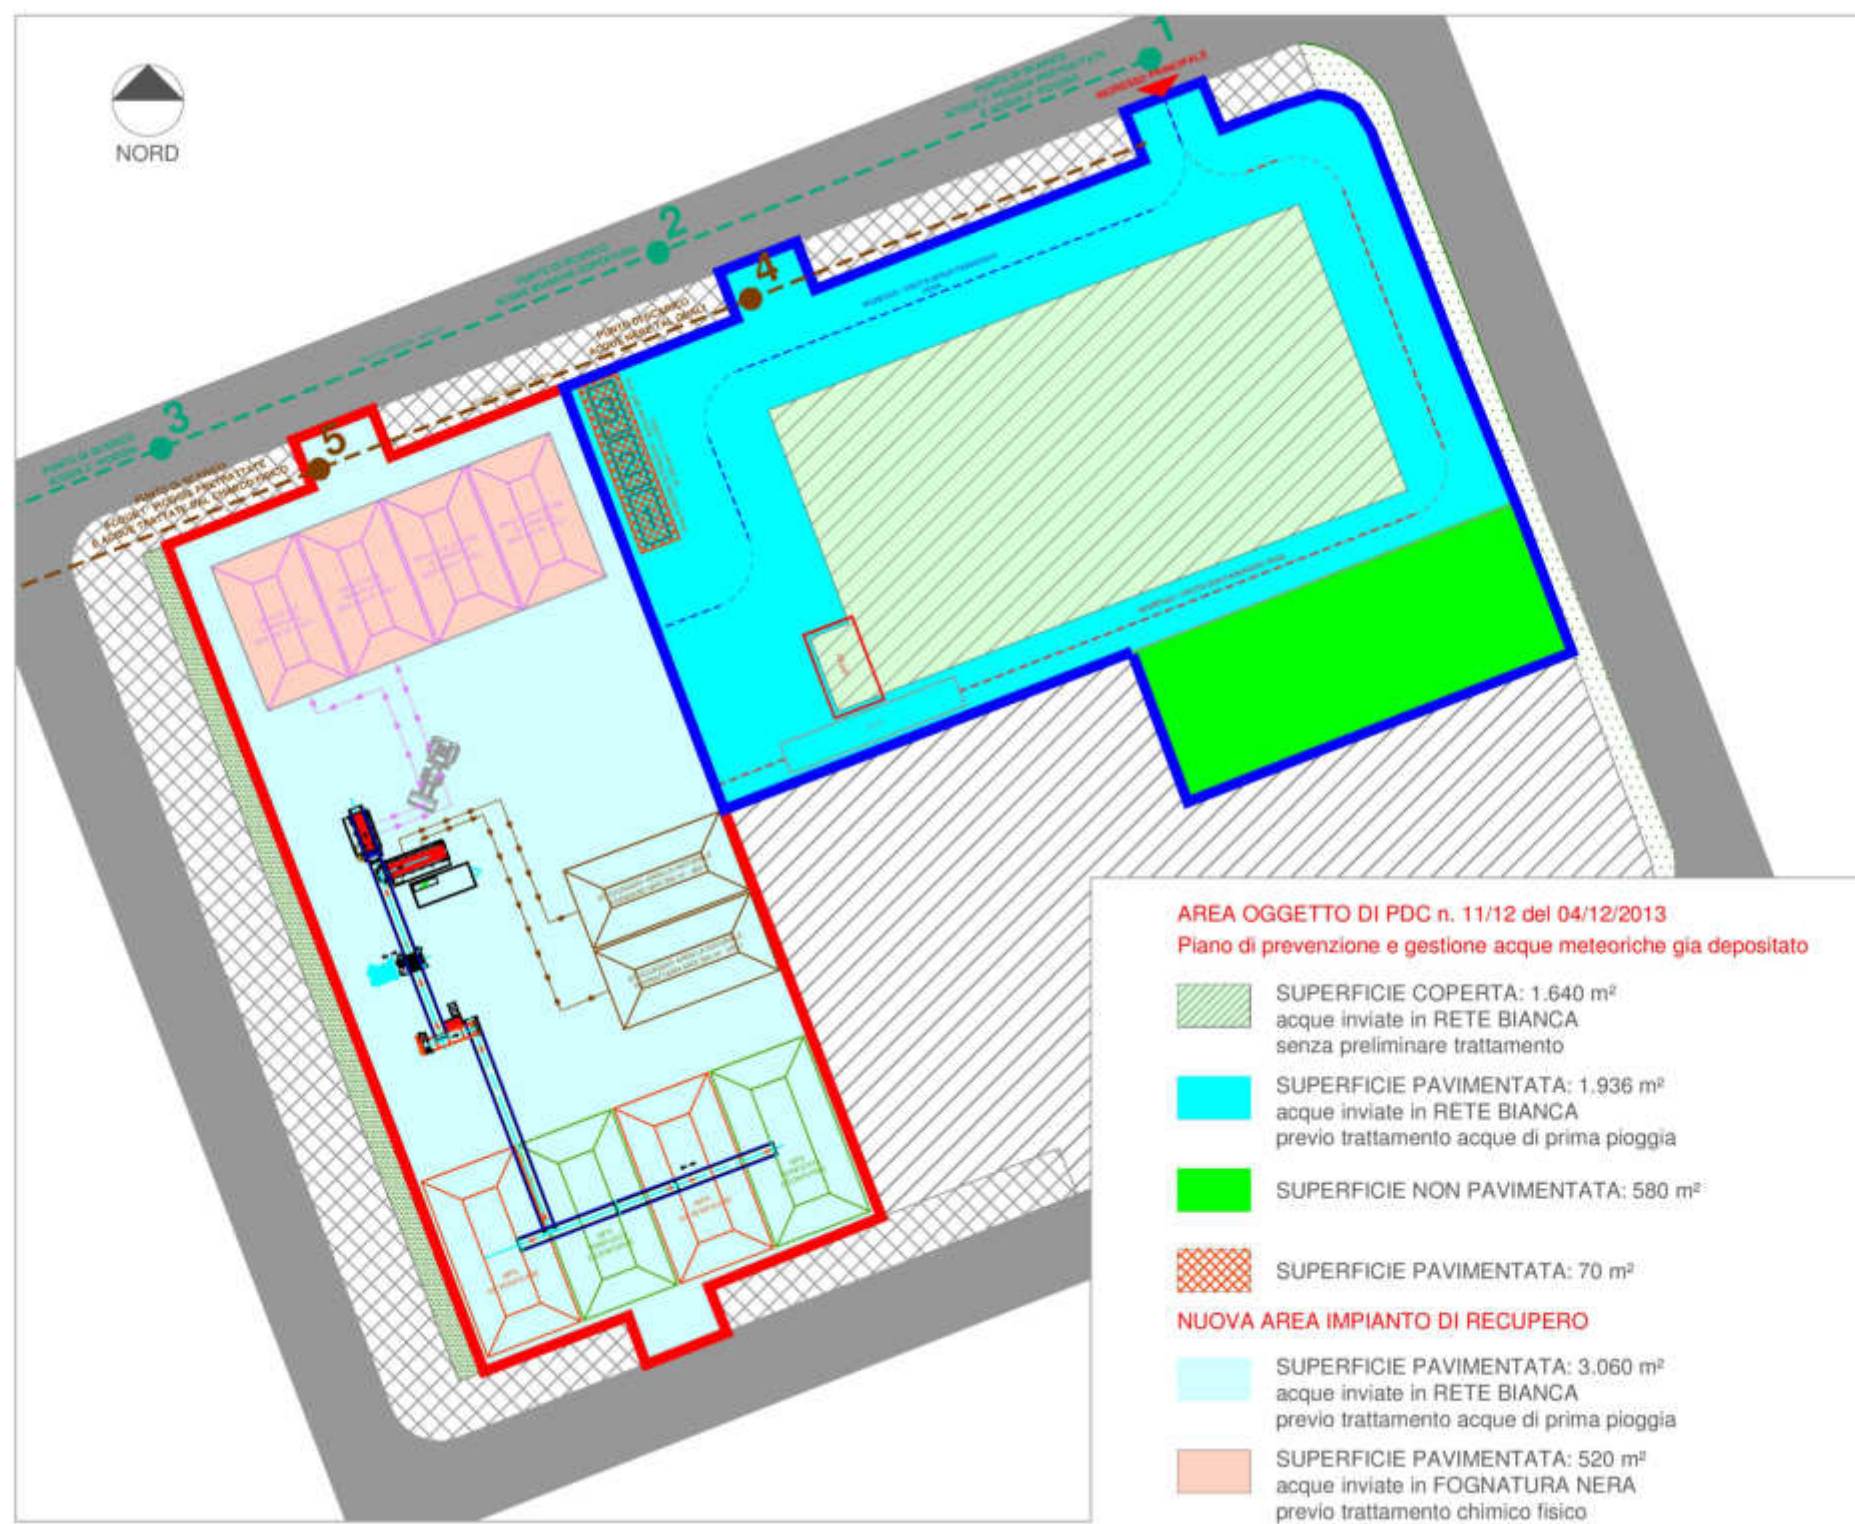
Planimetria delle superfici scolanti e dei punti di scarico
